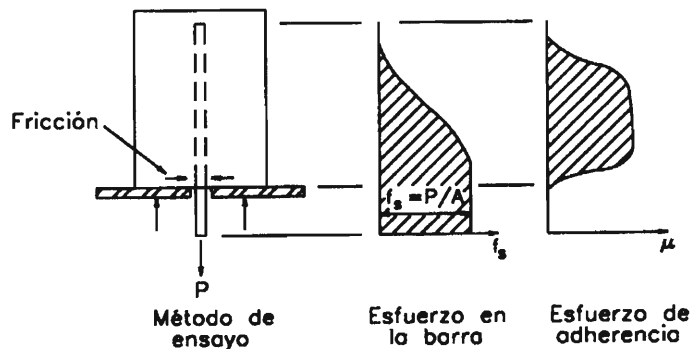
Ensayo para la determinación de la adherencia concreto-acero. (Ref. 24)
